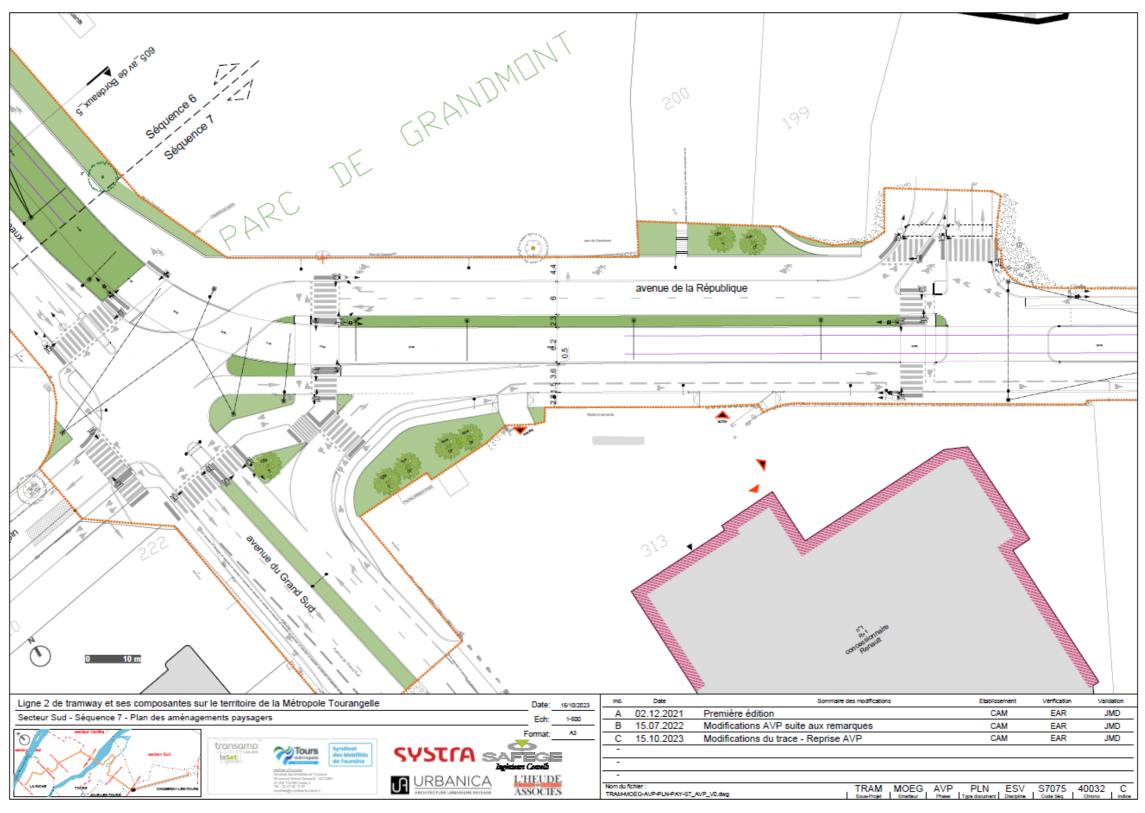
plan masse de localisation des arbres à abattre sur avenue de la République – Section 1 (planche 3)
